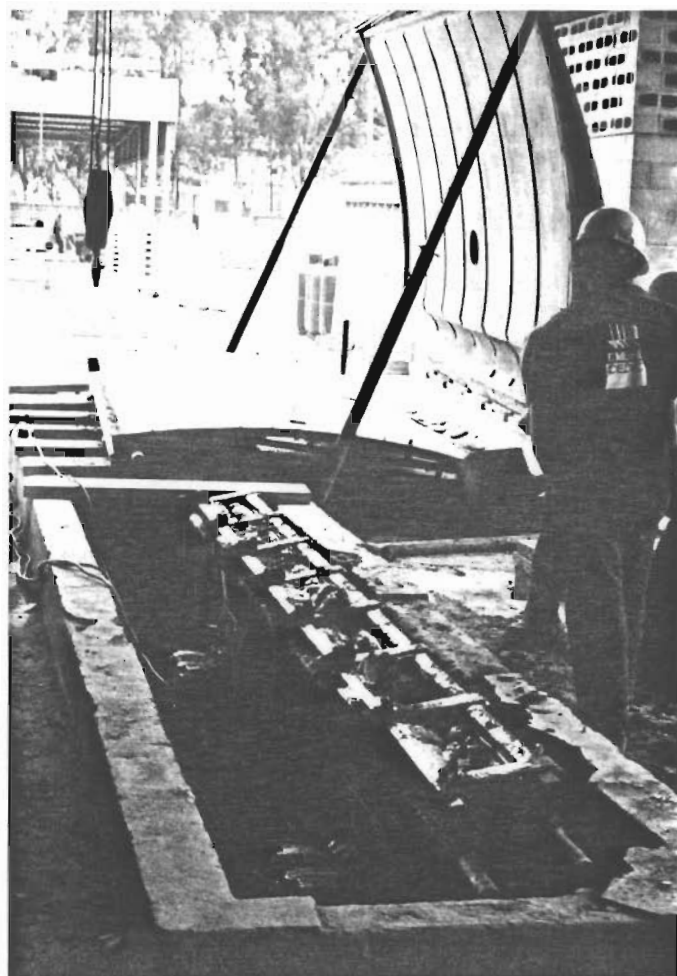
Detalhe de fôrma metálica de uma cobertura de abrigo de ônibus
